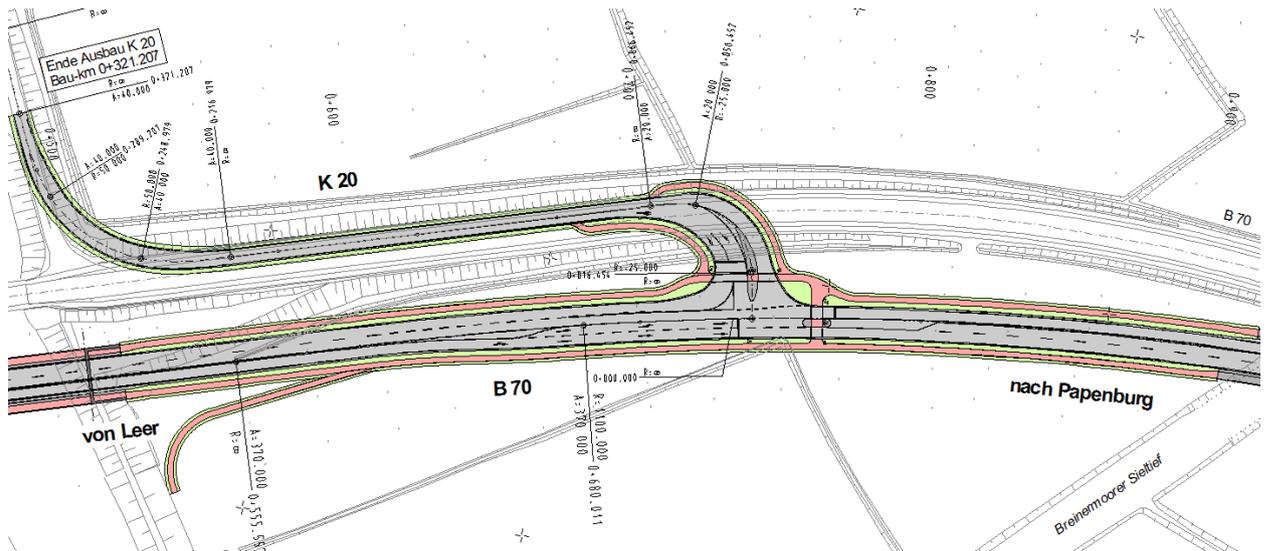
Planausschnitt Knotenpunkt B 70 / K 20 Ausbauvariante 1
